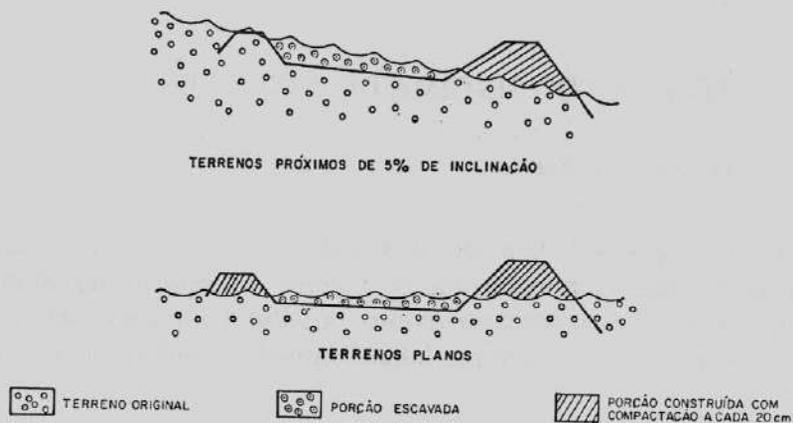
Configuração esquemática da escavação de viveiros em terrenos suavemente inclinados ou planos
